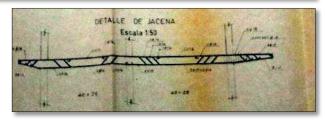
Plano original Archivo Histórico de Gandía. Plano de cimientos. Plano de estructura. Detalle jácena.
